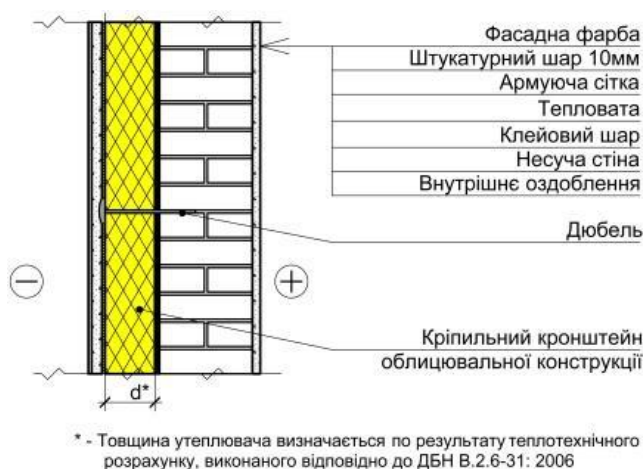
Схема утеплення фасаду "мокрим" методом в розрізі
